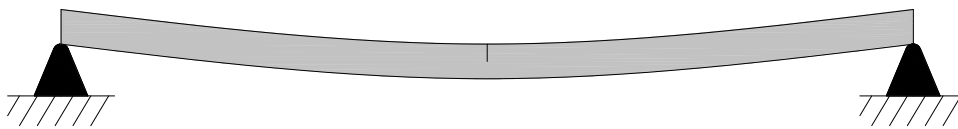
Fisura cerrada debido a la acción de la gravedad y a la posición de la propia fisura.
